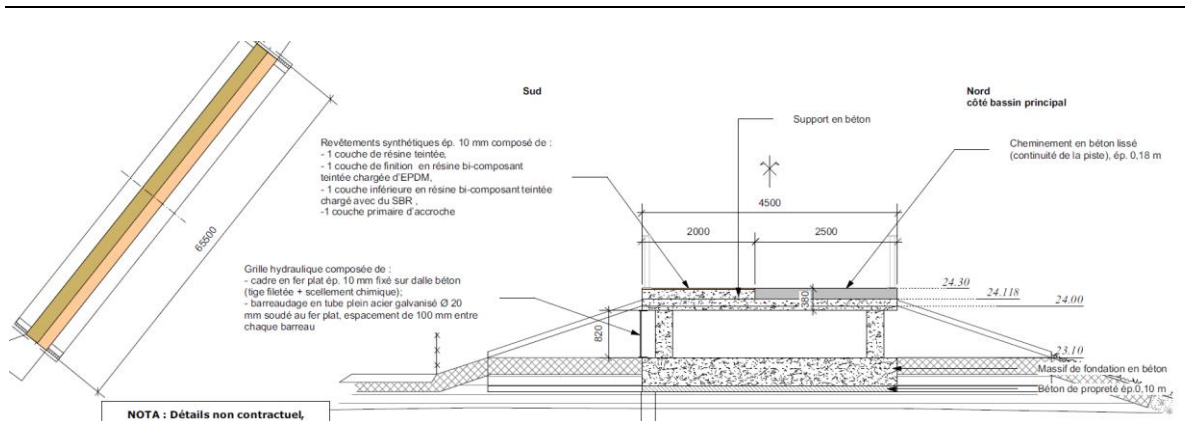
profil vue en élévation de la passerelle sur ouvrage amont depuis l'extérieur du parc
